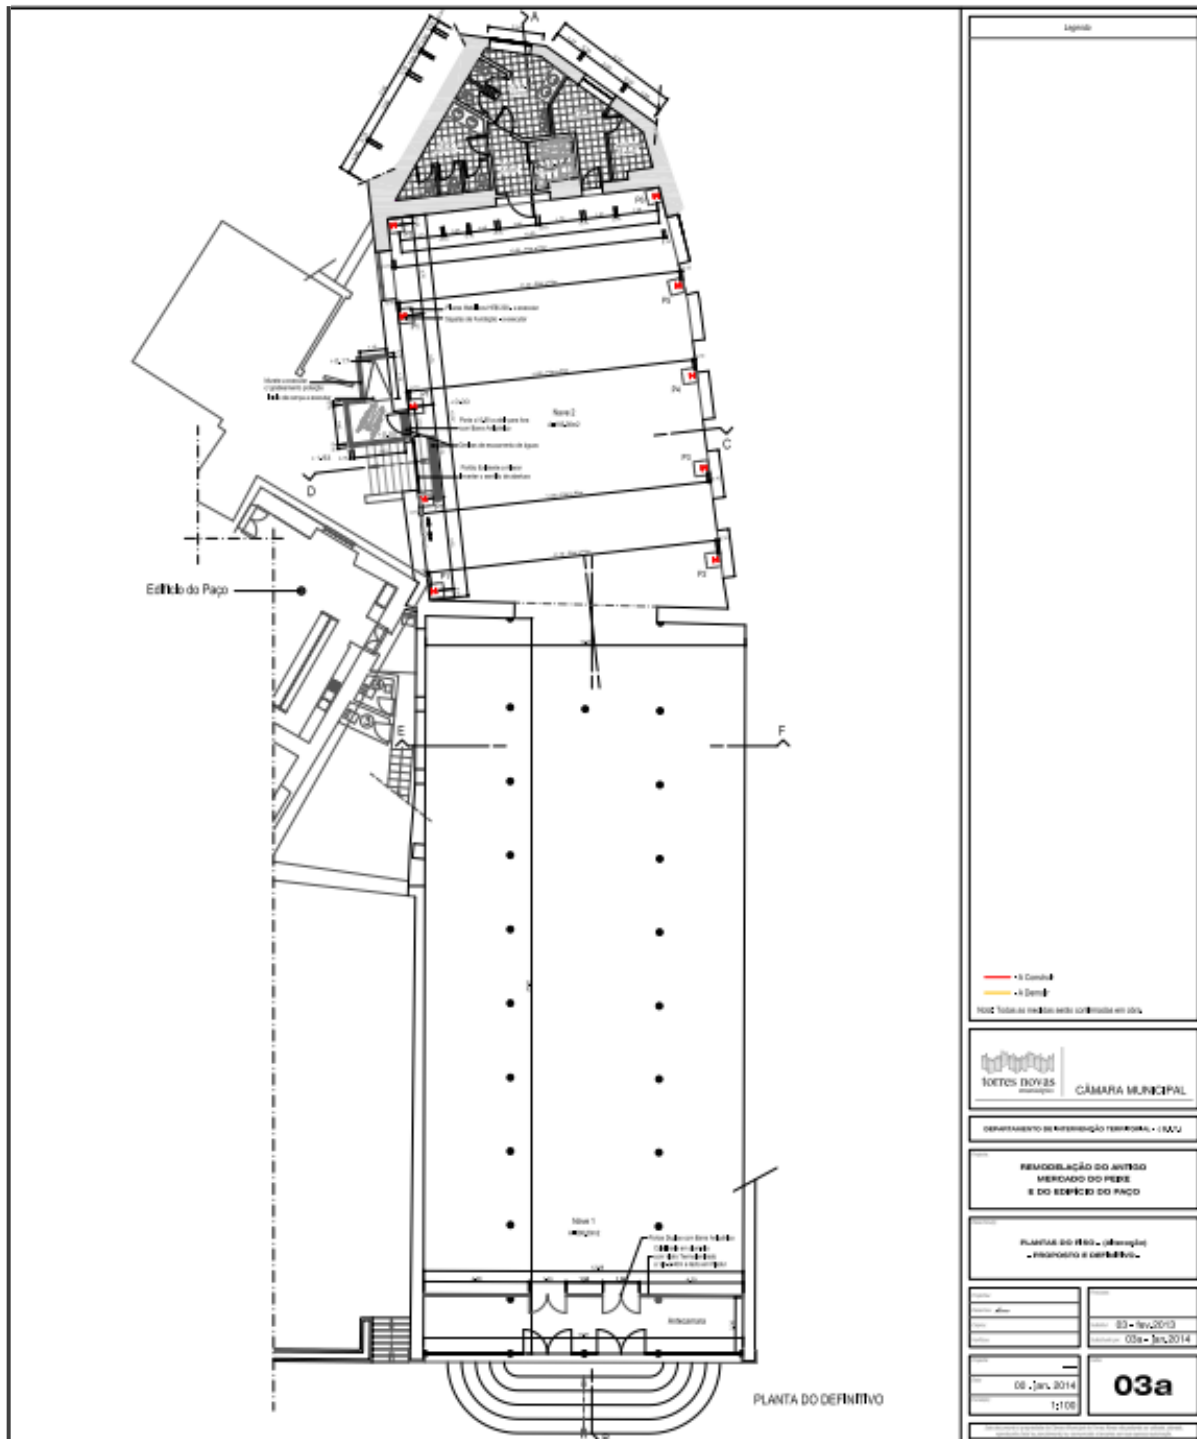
Planta do Edifício Praça do Peixe. Projeto de Álvaro Campos.
